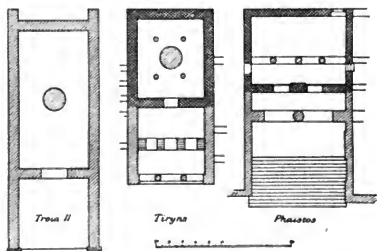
Grundrisse der drei Megara. (S. 76.)
